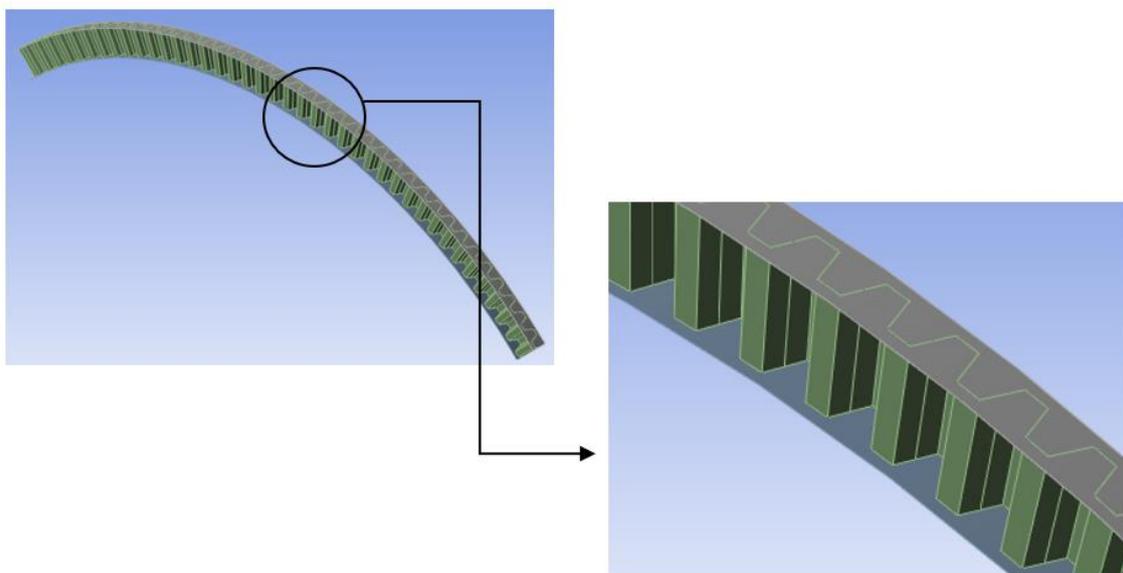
Arco circular de sección 'I' con alma corrugada trapezoidal.
